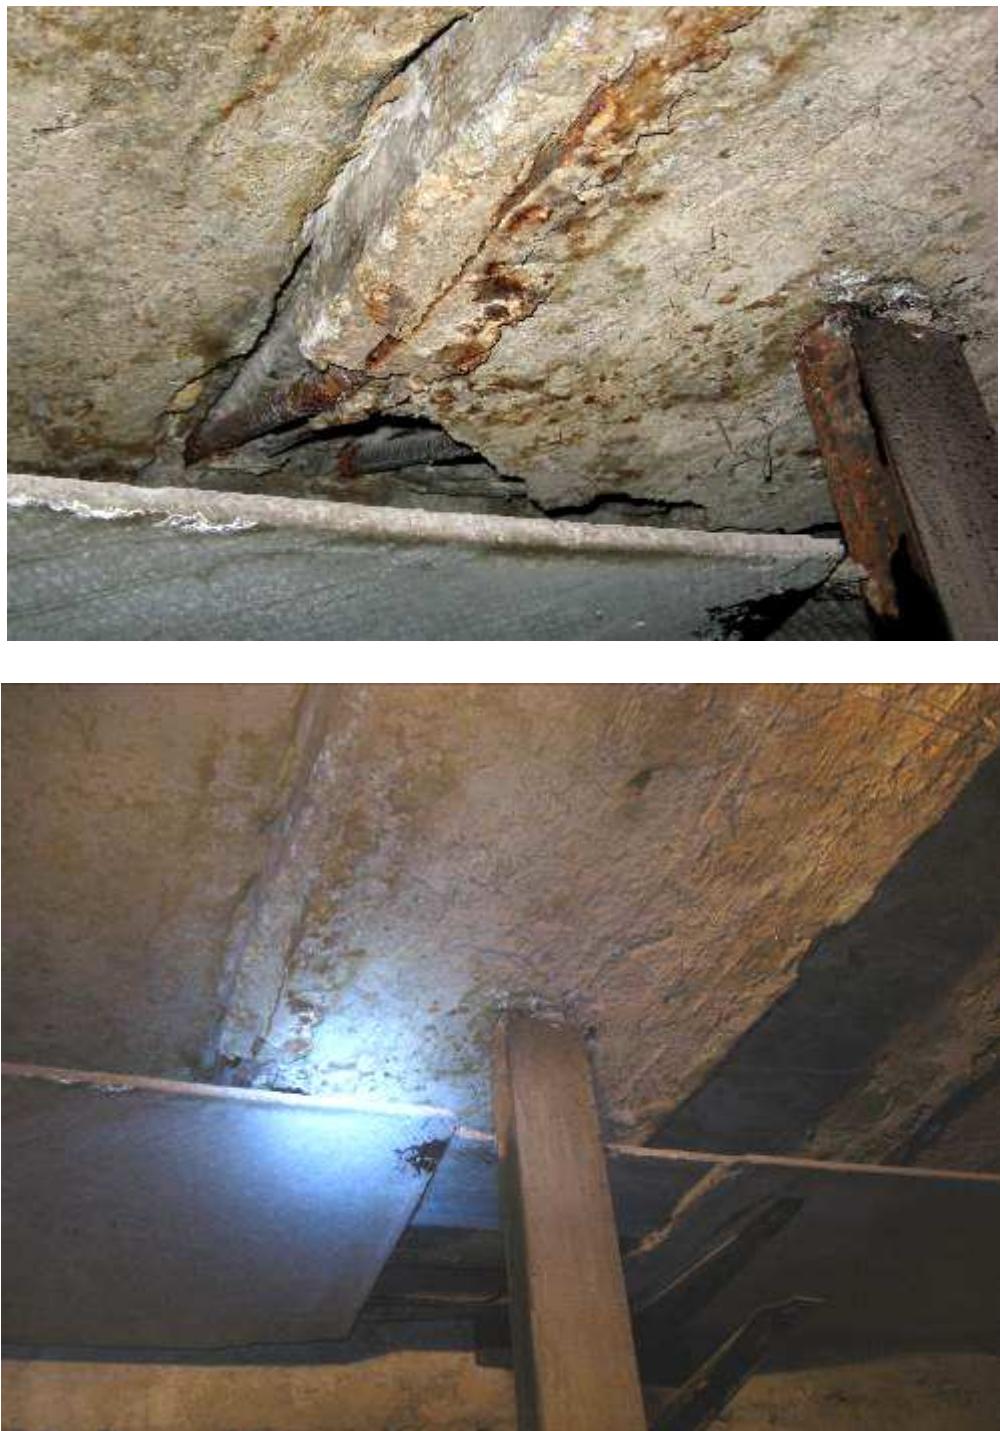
Разрушение плиты покрытия тоннеля
